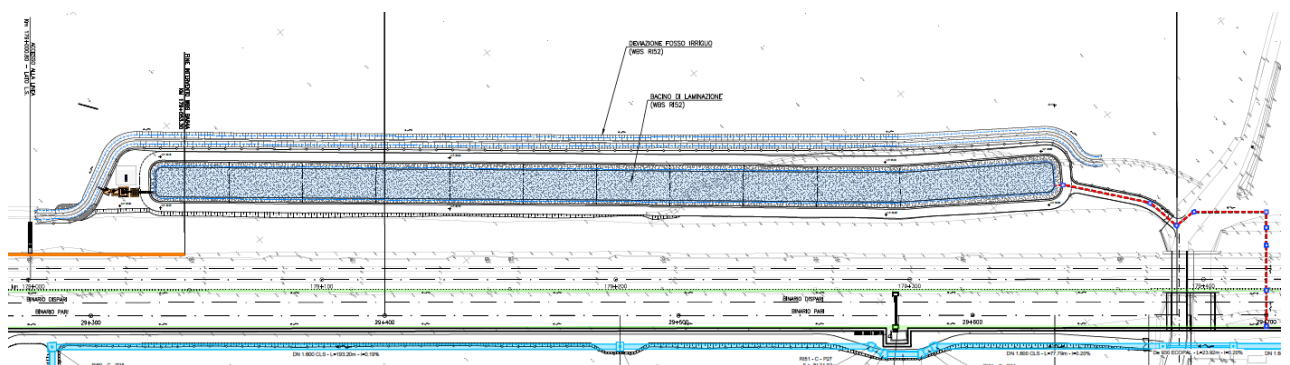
Stralcio planimetrico di inquadramento del bacino di laminazione
